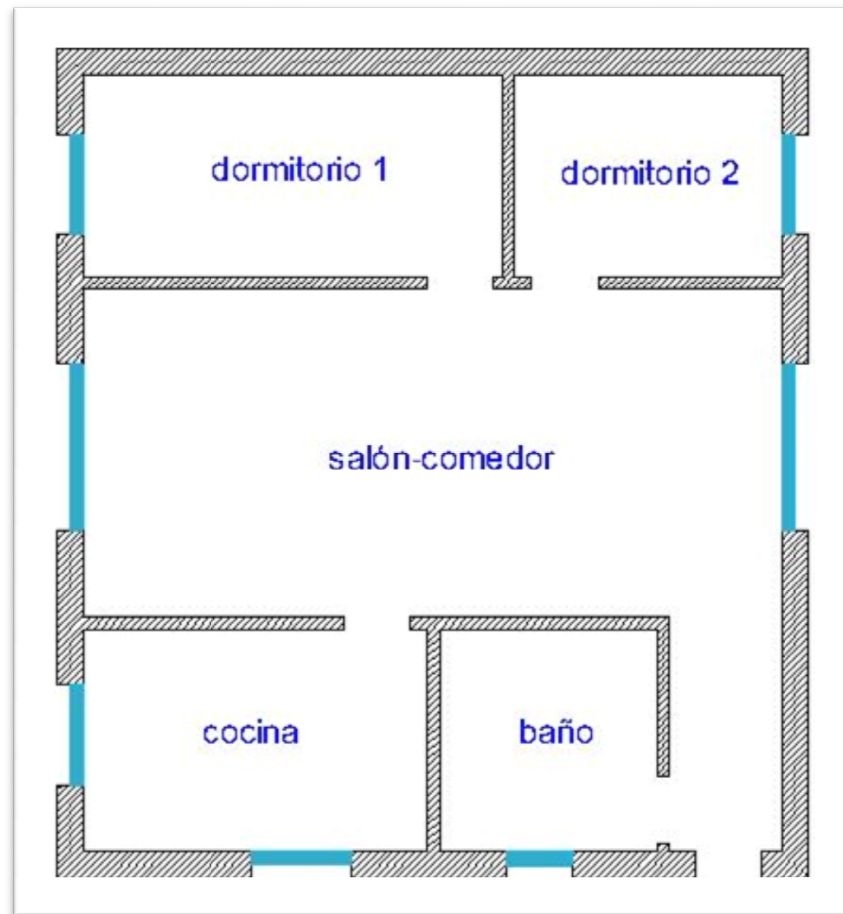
Plano vista planta de la vivienda. (Elaboración propia)
